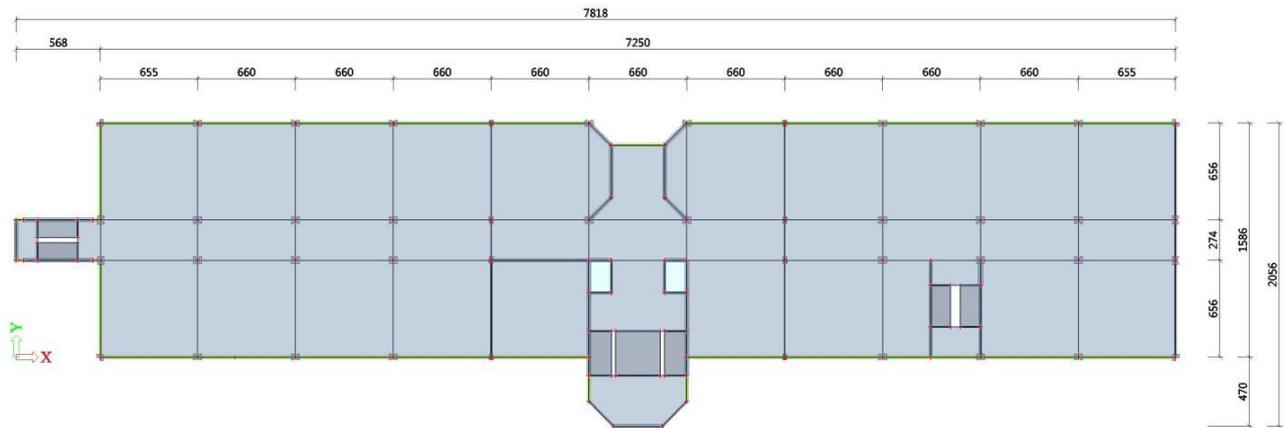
Modell; Grundriss 2.OG; Maße in cm
